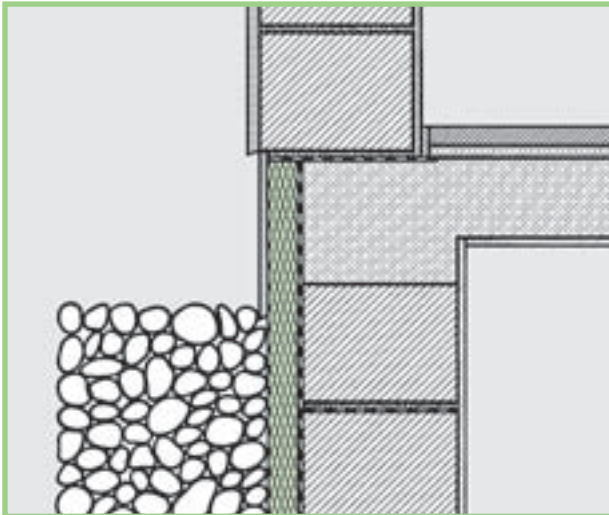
Zócalos, aislamientos perimetrales con mampostería vertical con aislamiento térmico.
